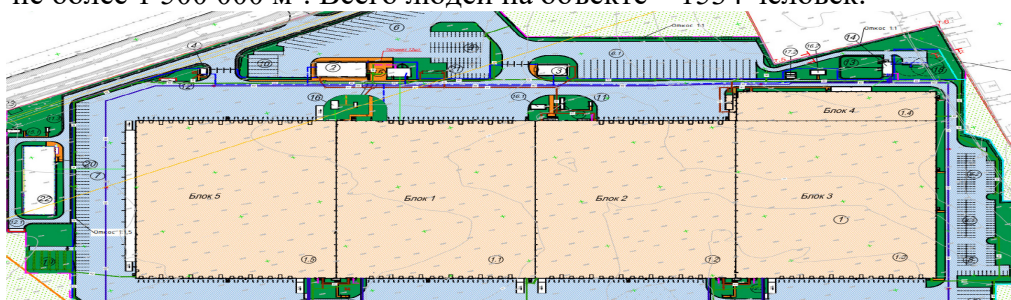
План универсального склада продовольственных и непродовольственных товаров
